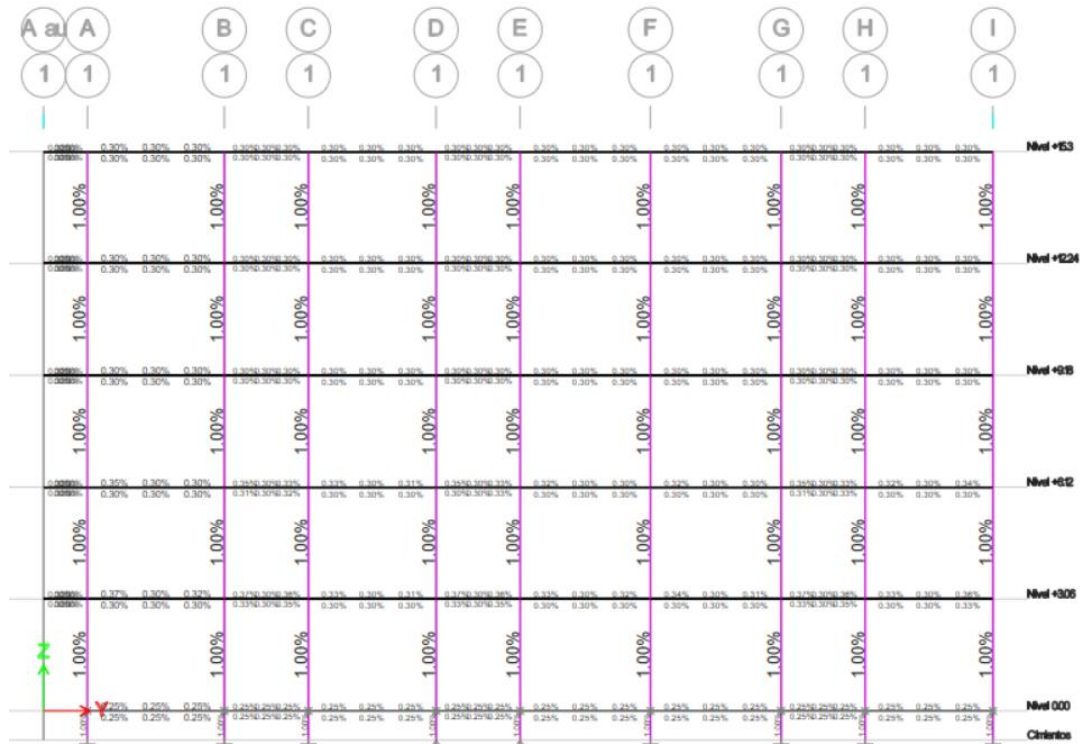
Refuerzo longitudinal para columnas (Eje 1 (A-I)). Tomado de ETABS 2020
